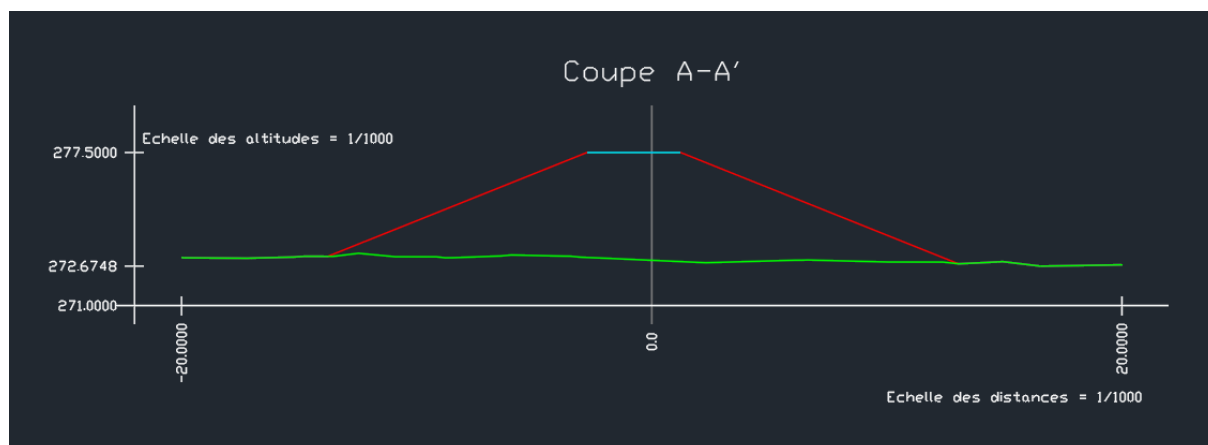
Coupe topographique A-A' : corps de l'ouvrage
